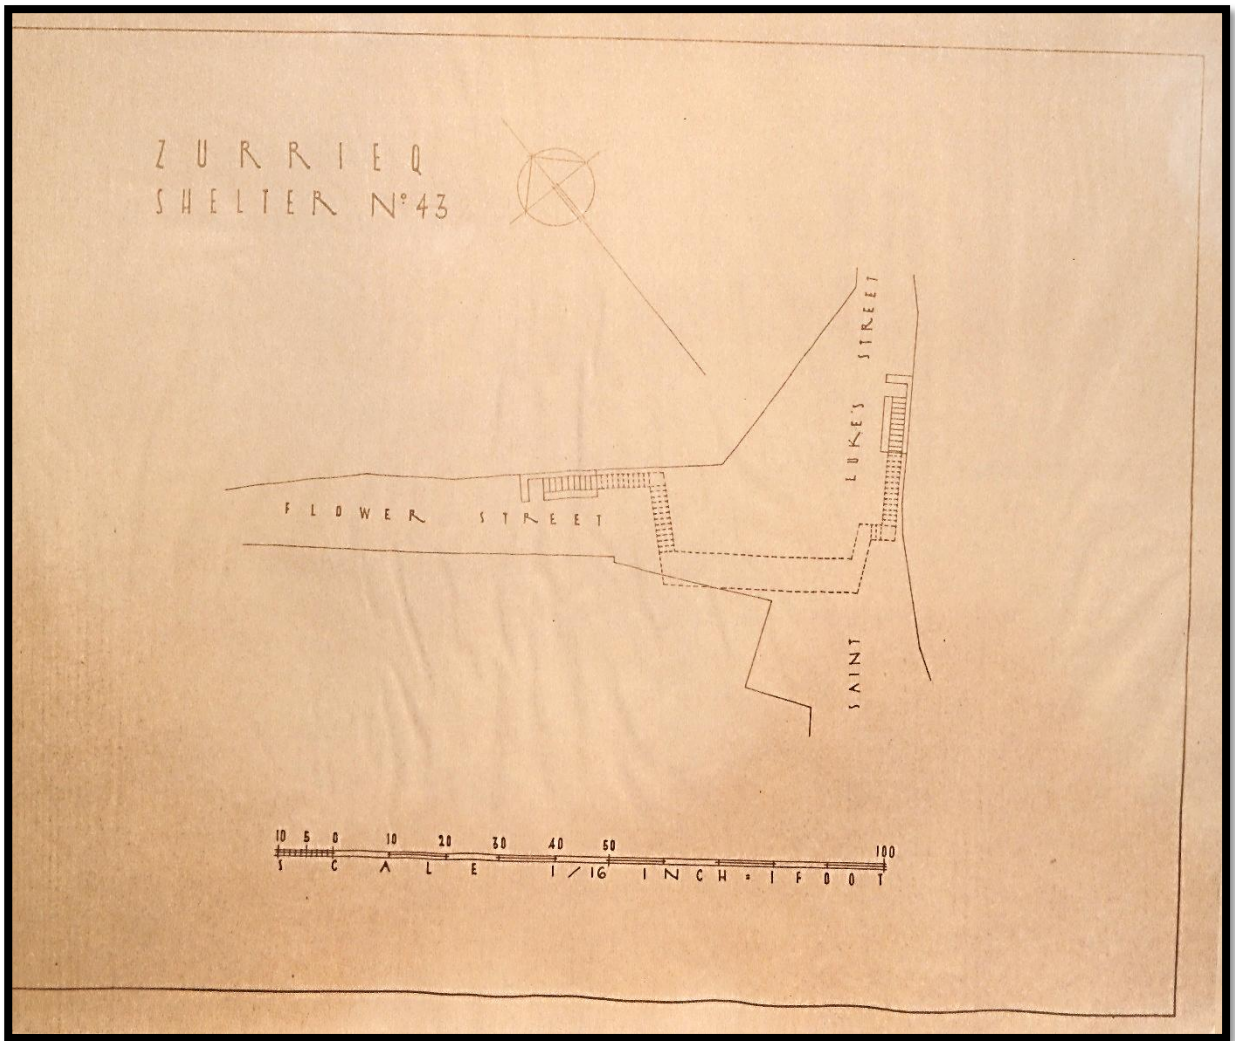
Planta do Abrigo nº43 "Flower Street – Saint Luke's Street."
